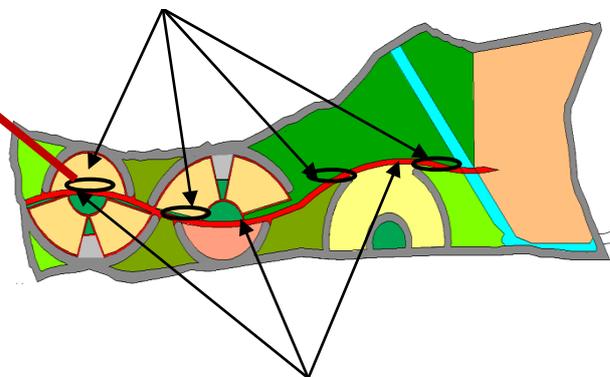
parkings des vélos dans le plan de masse (source : auteur)
